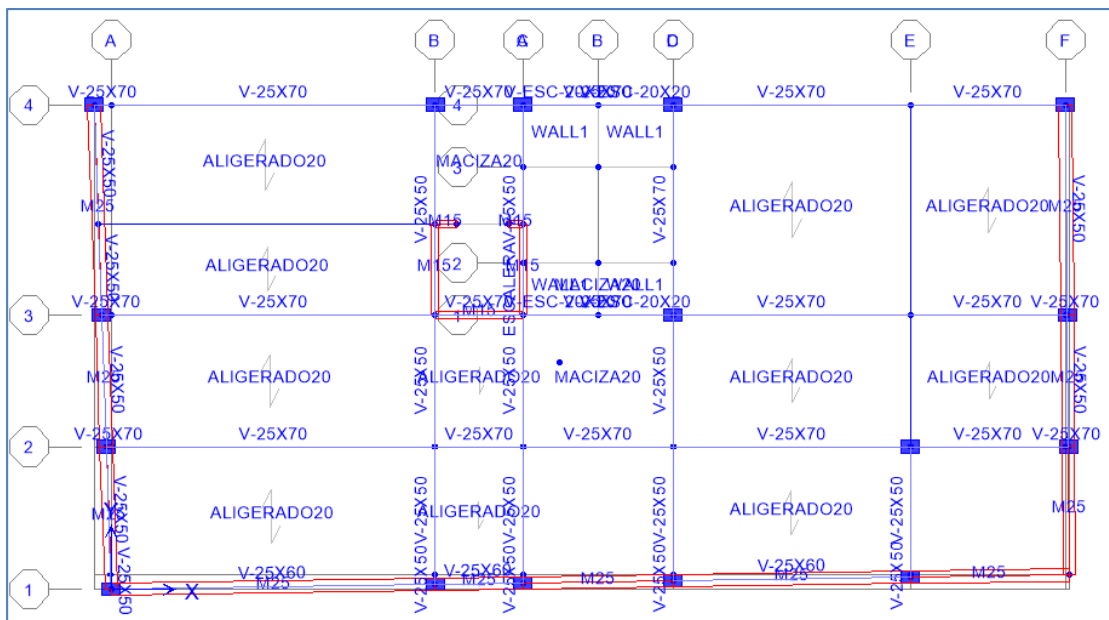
Vista en planta: columnas, vigas, muro y placa plasmada en el ETABS. Alternativa 02
